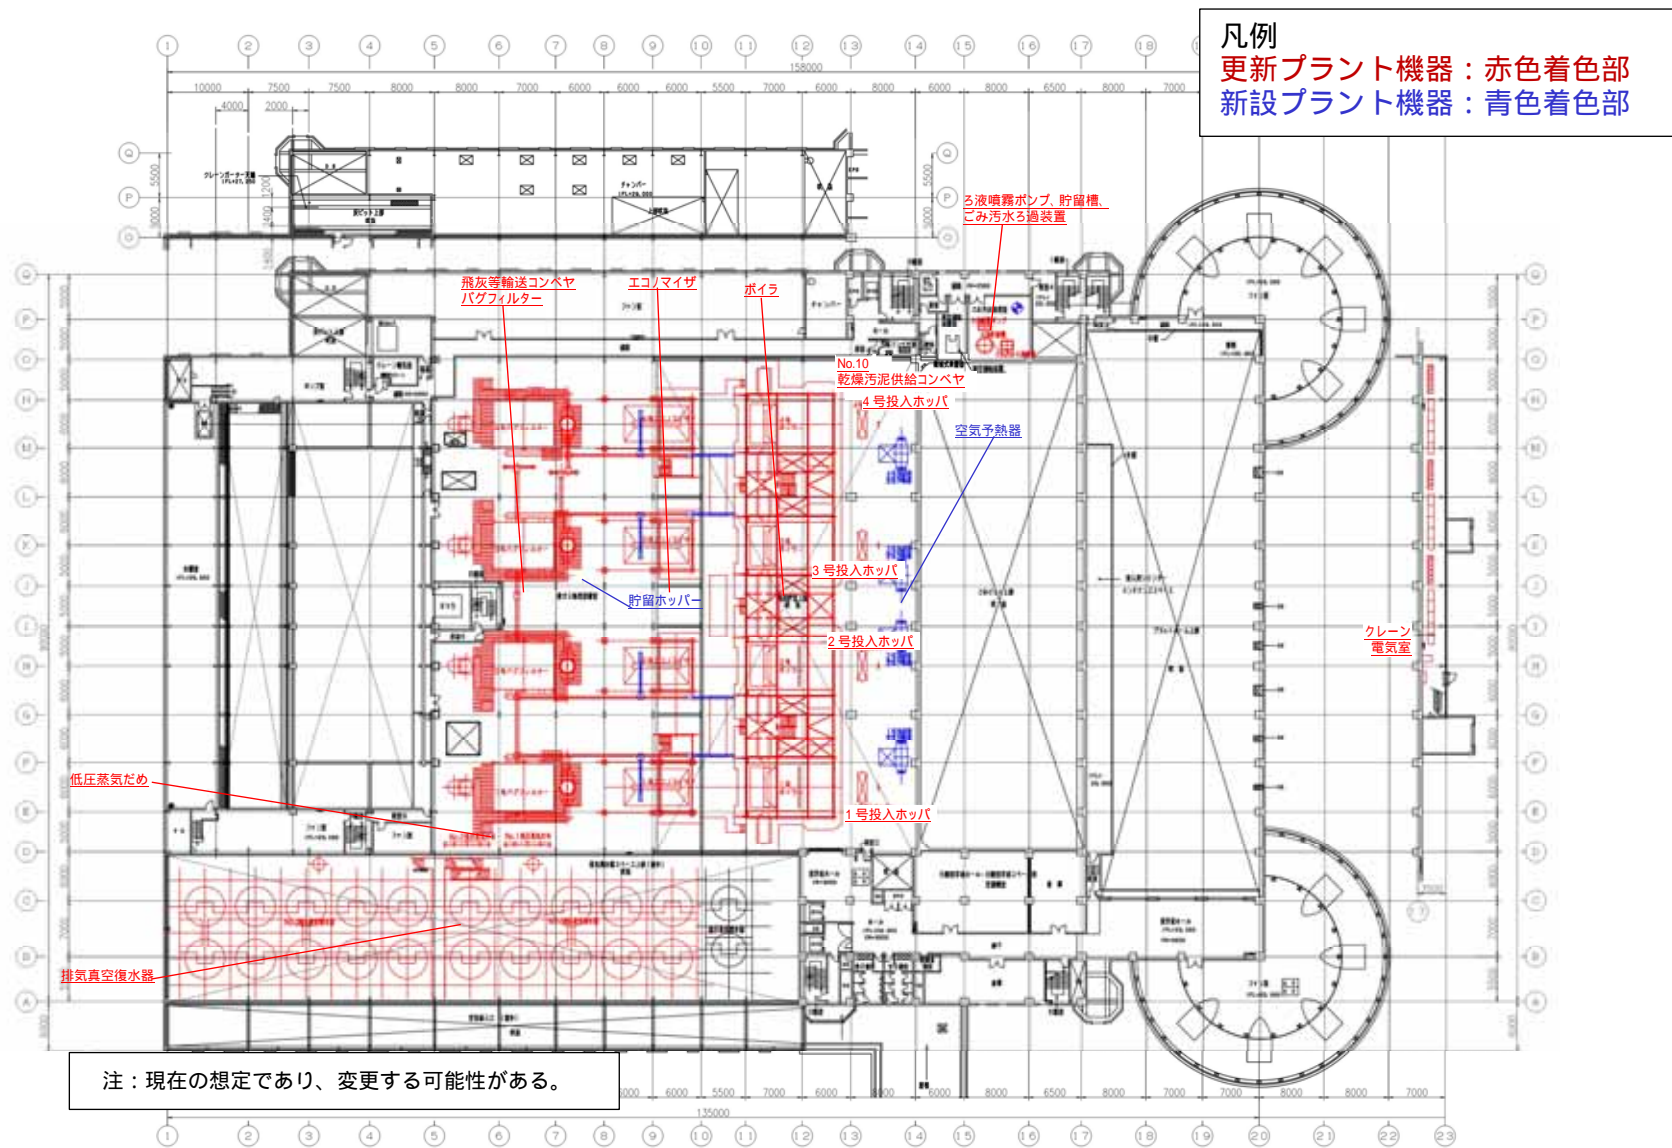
(6) 設備機器の更新箇所 (6・7階平面図)
